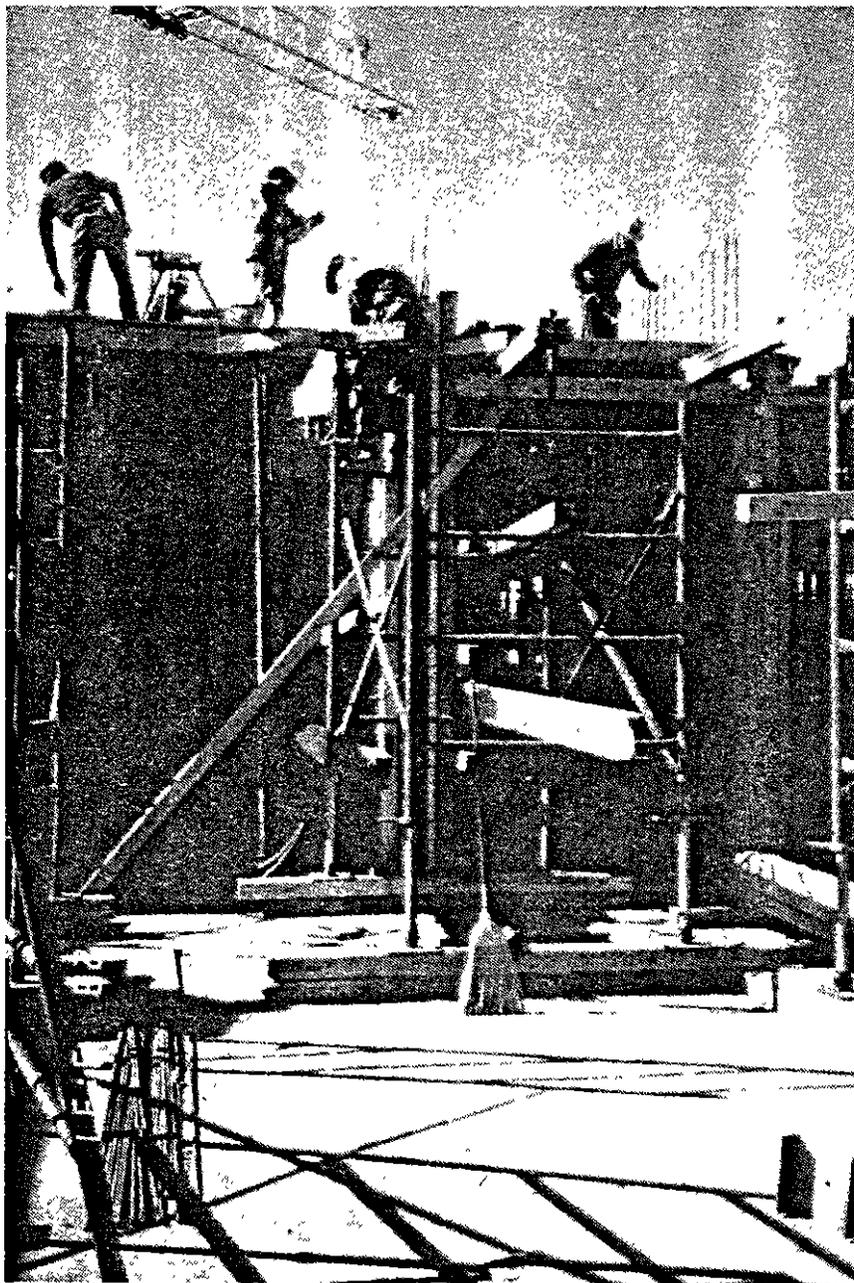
· ESPACE DE TRAVAIL RÉDUIT POUR MONTER LE COFFRAGE DE MUR
